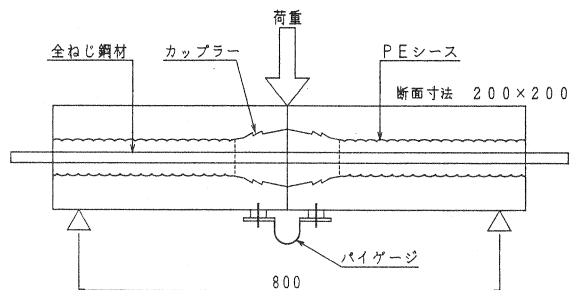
供試体の形状寸法とひび割れ導入方法
